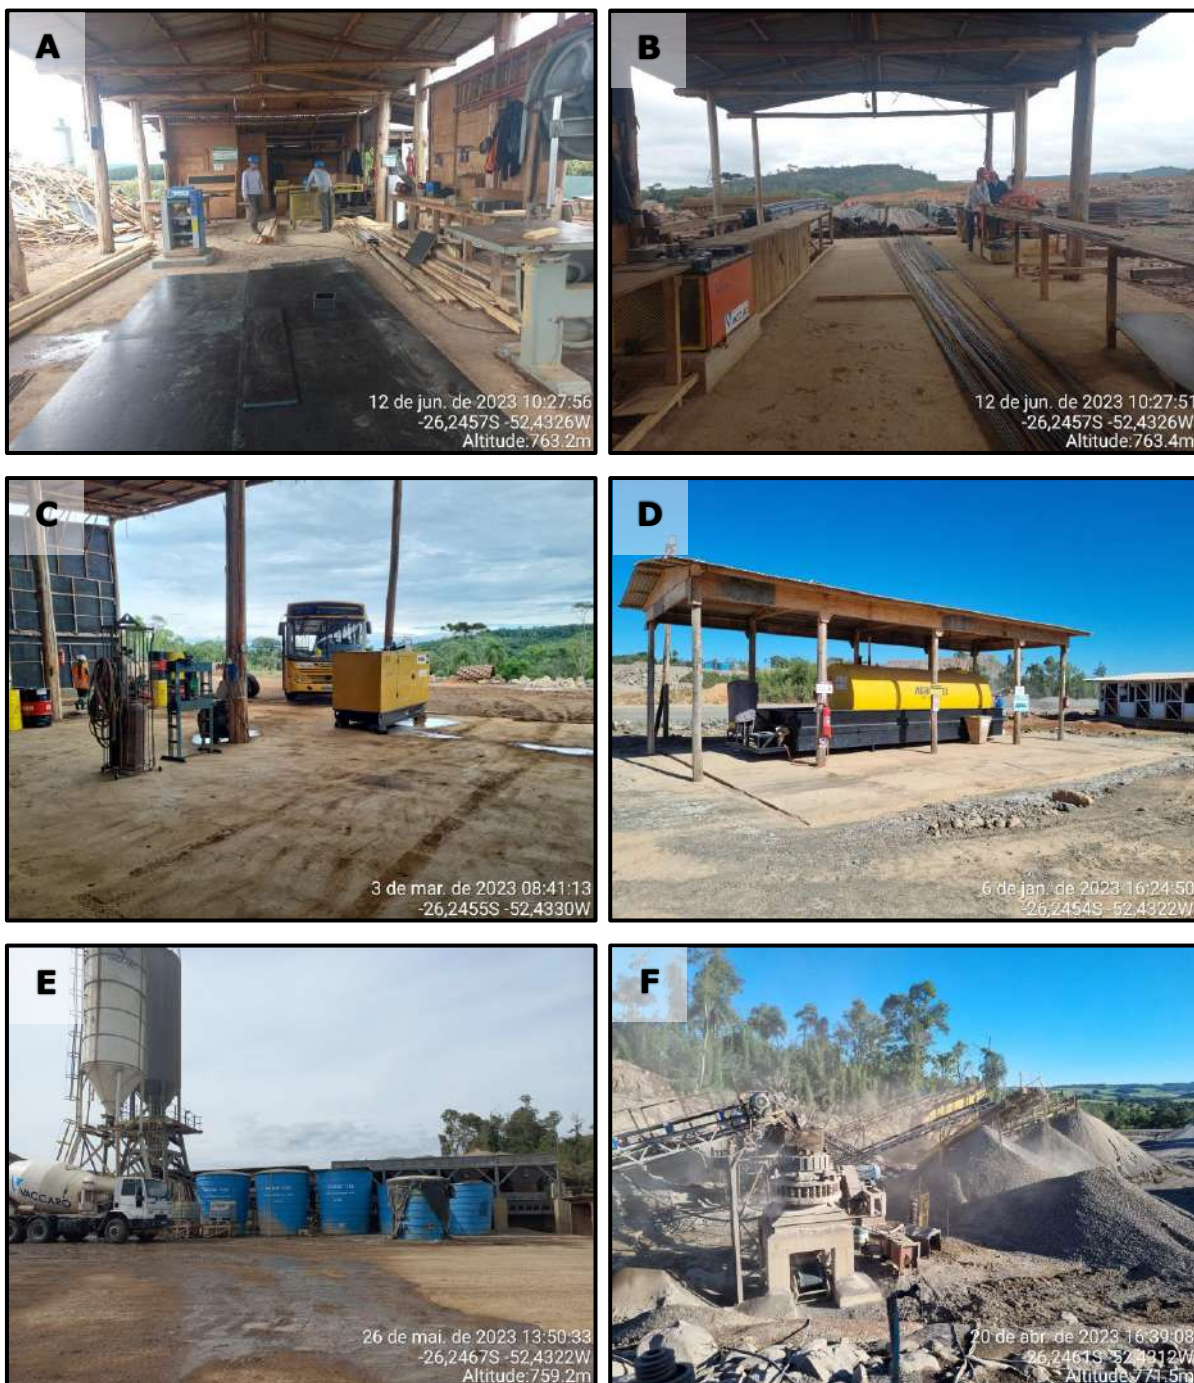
Acompanhamento das atividades nas estruturas do canteiro de obras da PCH São Luís.
